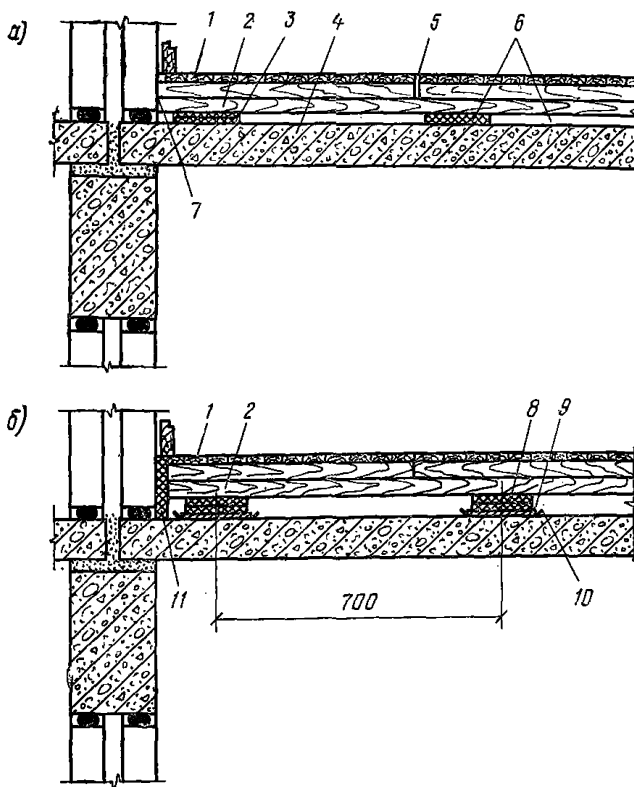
Улучшение звукоизоляции междуэтажных перекрытий в эксплуатируемых домах (серия 1-335А)
